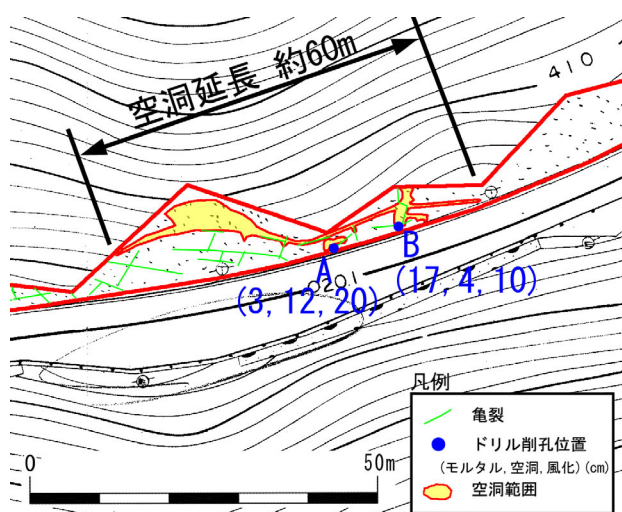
調査結果平面図 (No. 6区間) の一部抜粋
